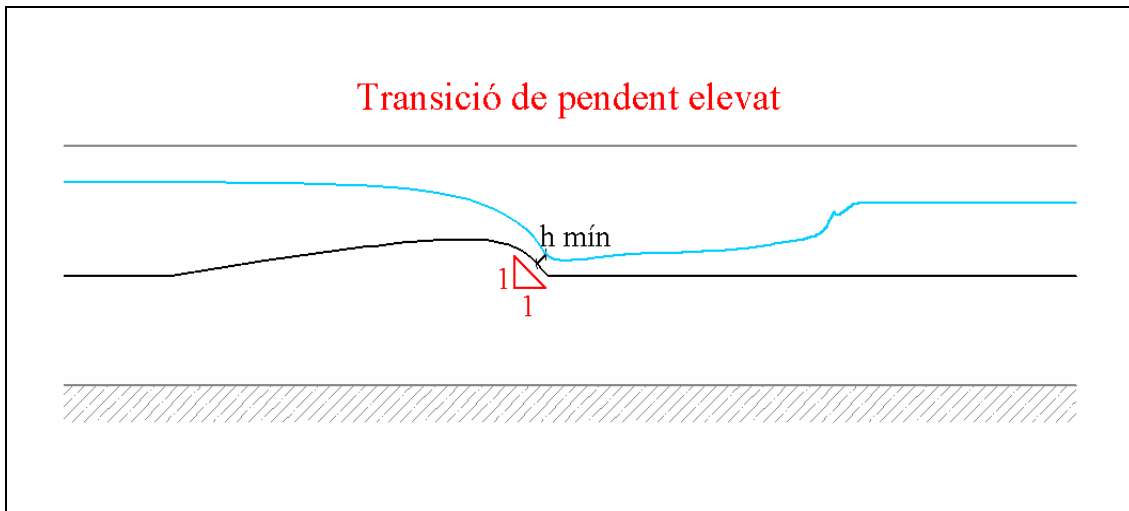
Dissipador d'energia a partir d'una transició de pendent elevat en la caiguda
